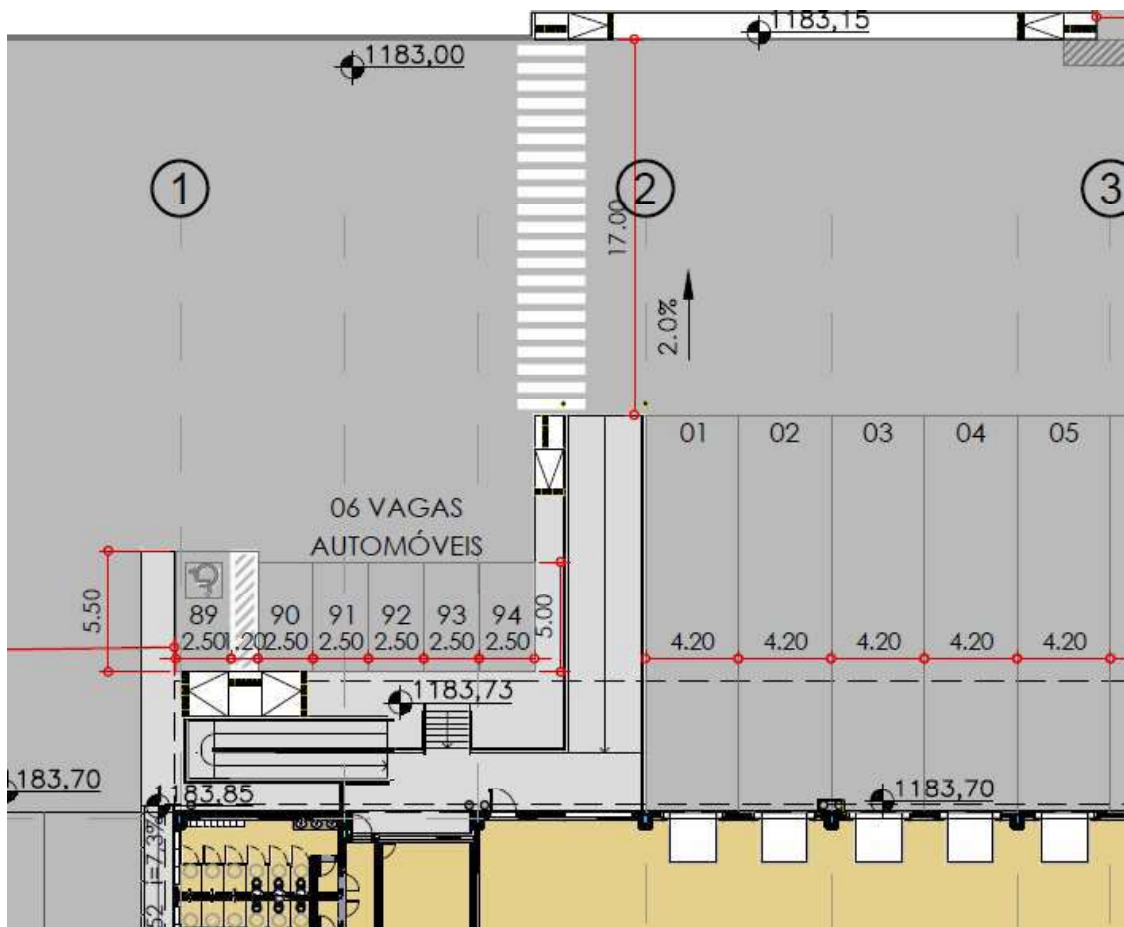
Sinalização de travessia para pedestres nos acessos ao galpão. Fonte: Recorte do Projeto de Arquitetura – R09, em anexo.
